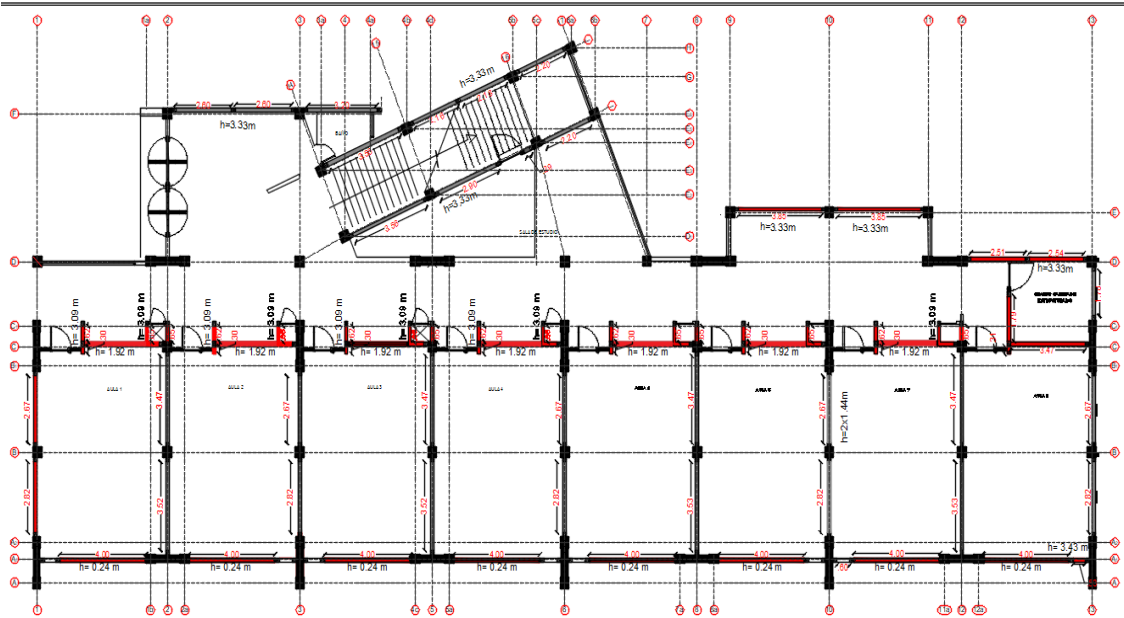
Planta general piso 1 – bloque 1 AUTOCAD Fuente propia
